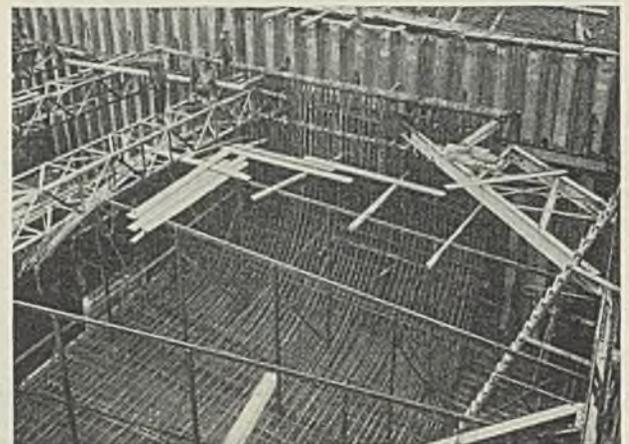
Bewehrung der Sohle für die Dockverlängerung.
